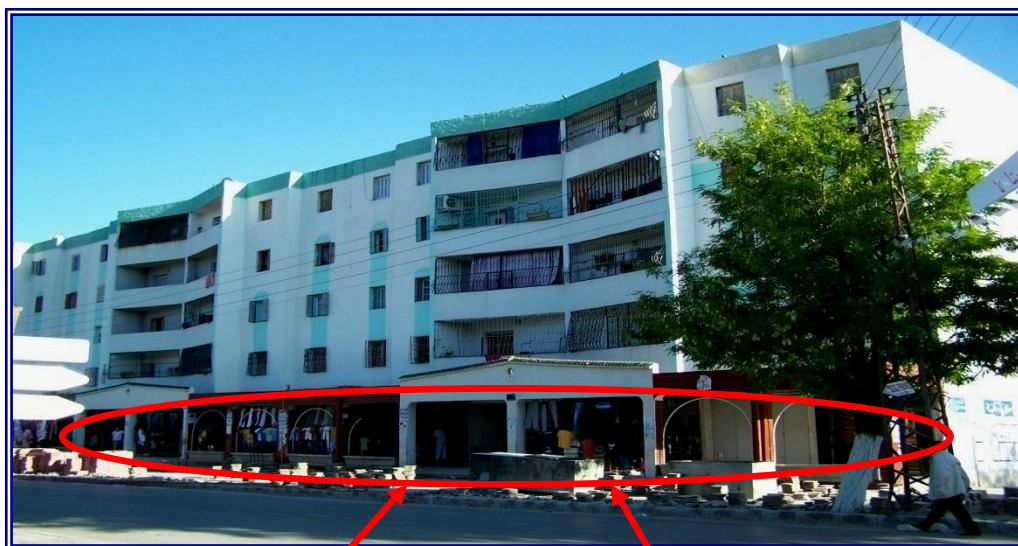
Exemples de surélévation au centre ville ancien
